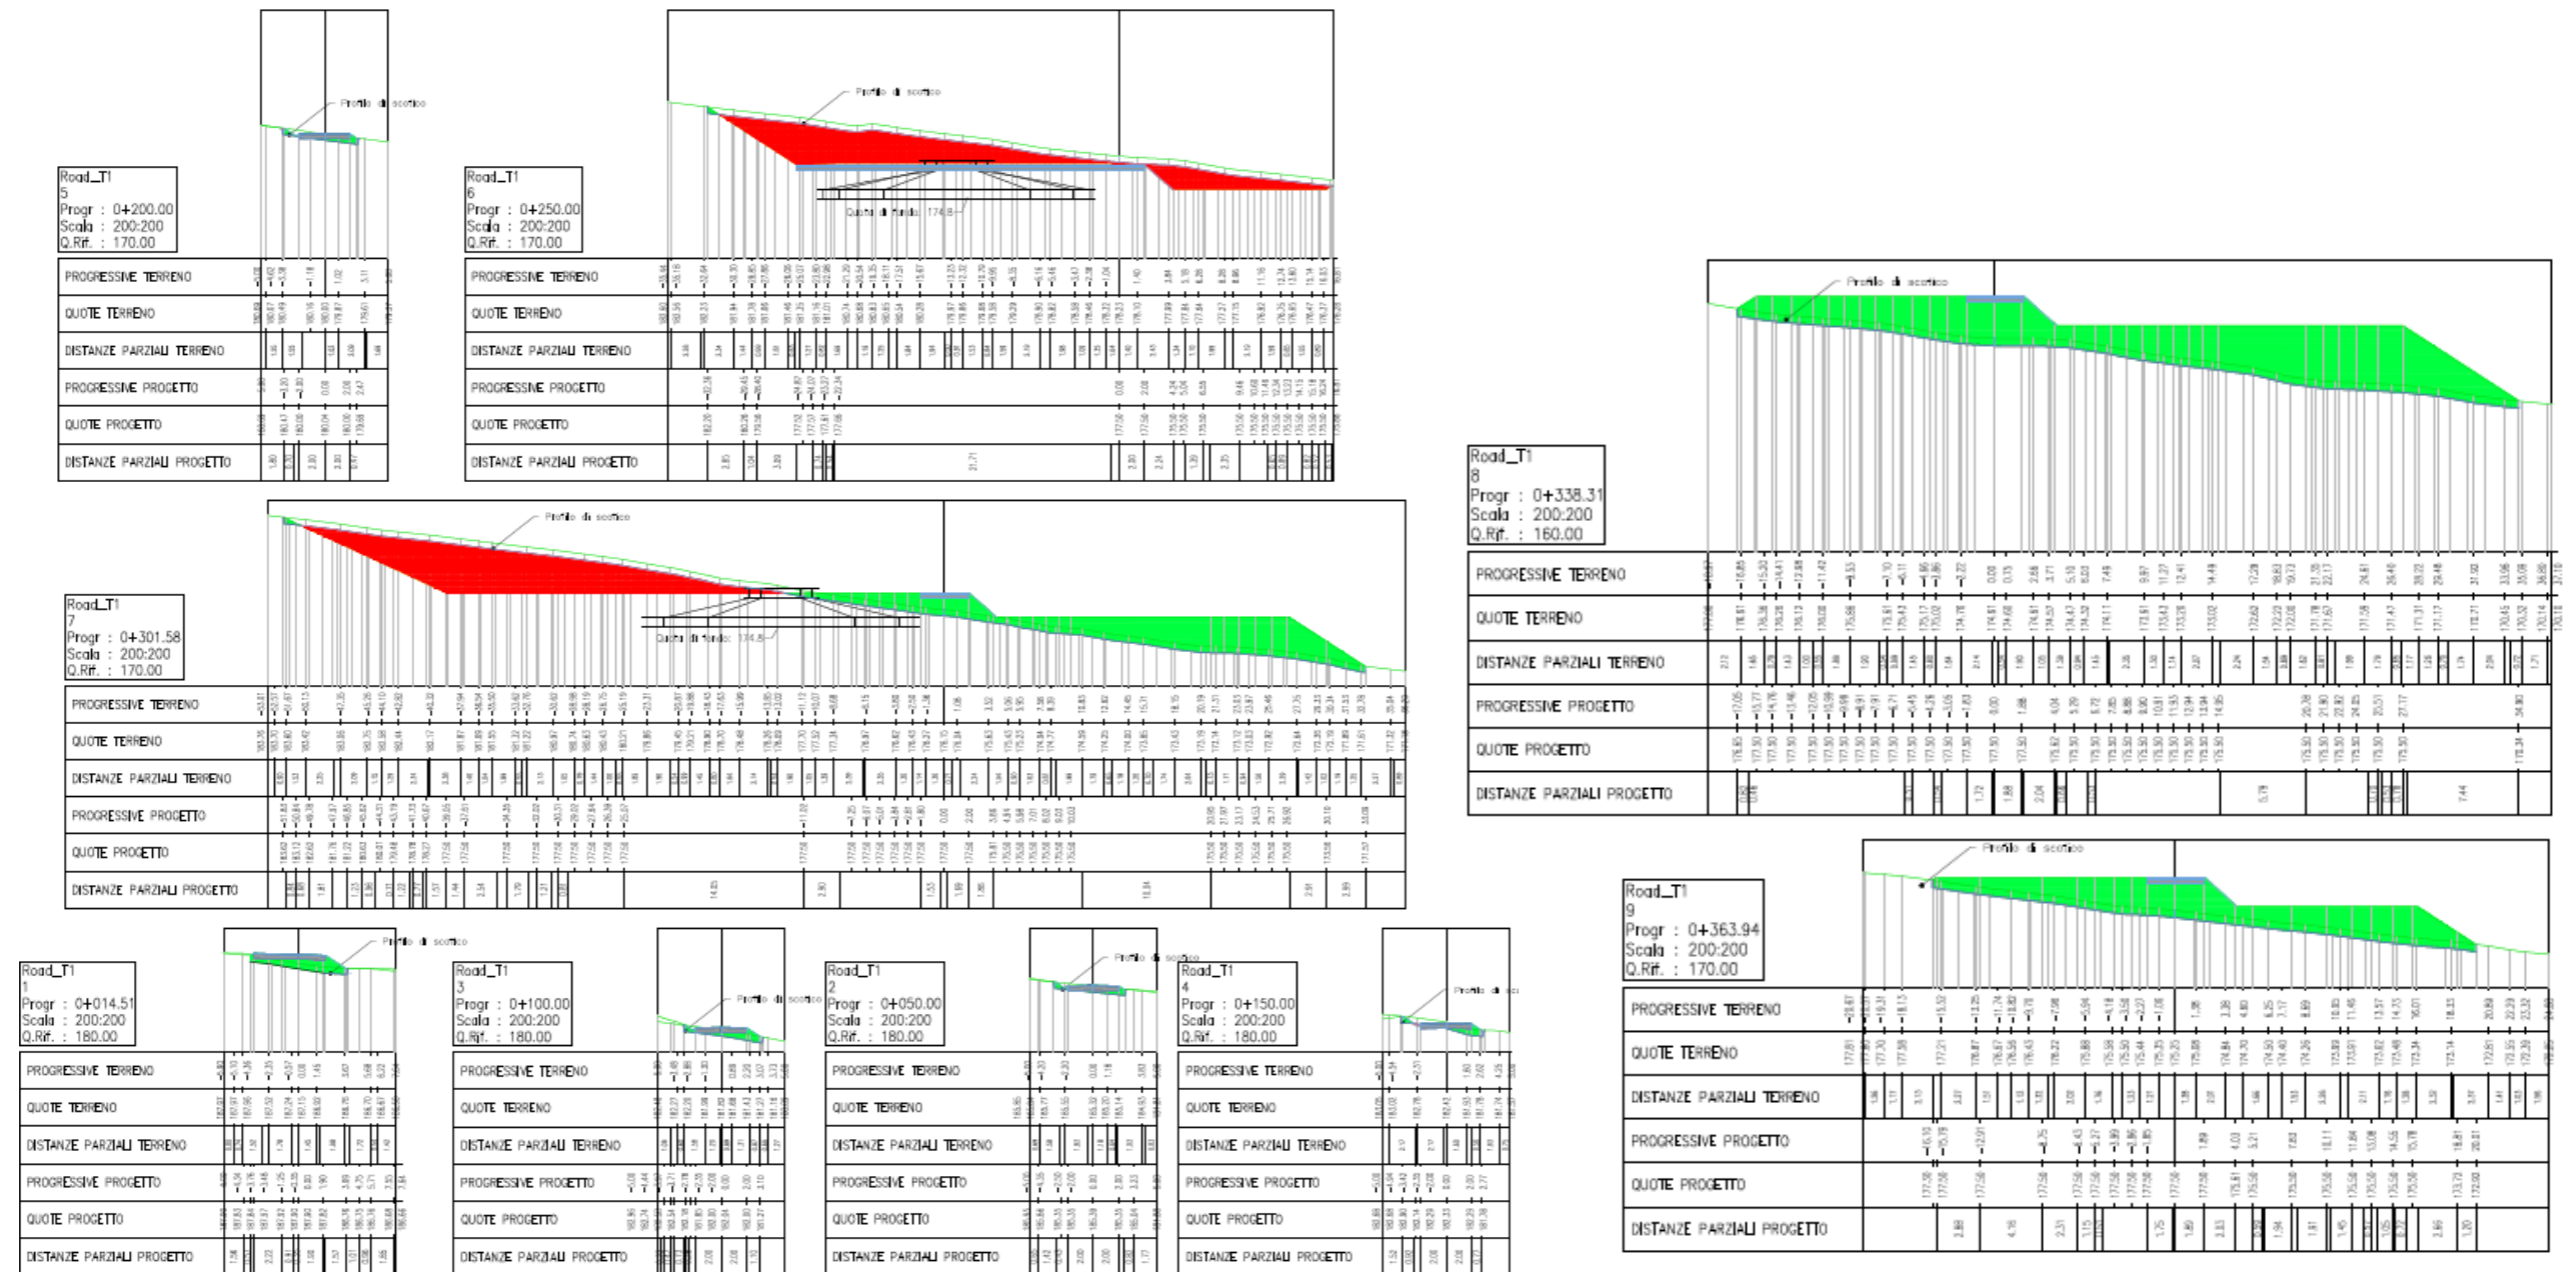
Sezioni trasversali della viabilità di progetto – T1
